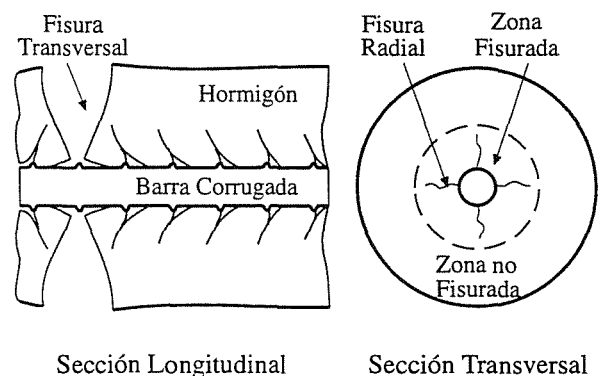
Fenómeno de agrietamiento por deslizamiento de una barra en el interior del hormigón.
